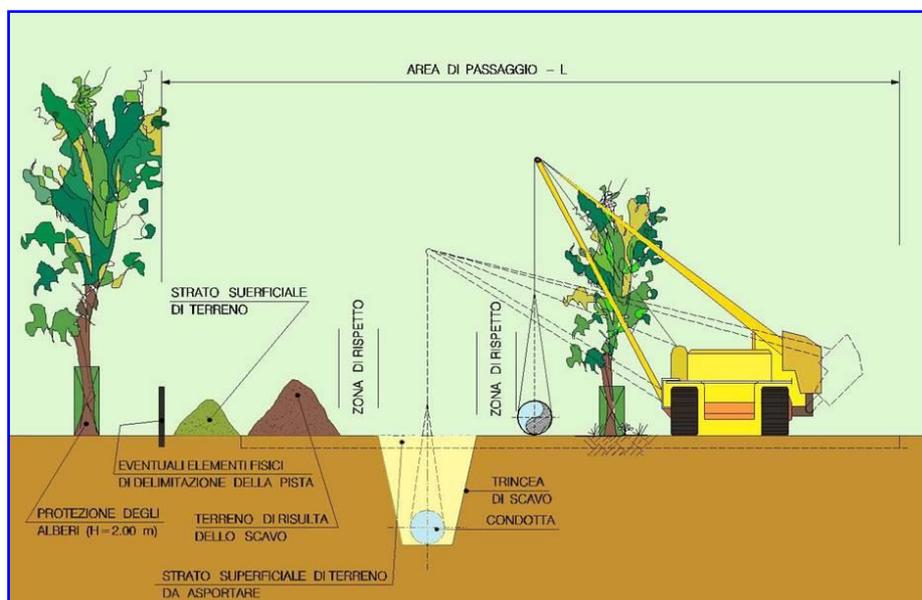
/A: Rappresentazione schematica della pista di lavoro con salvaguardia piante
